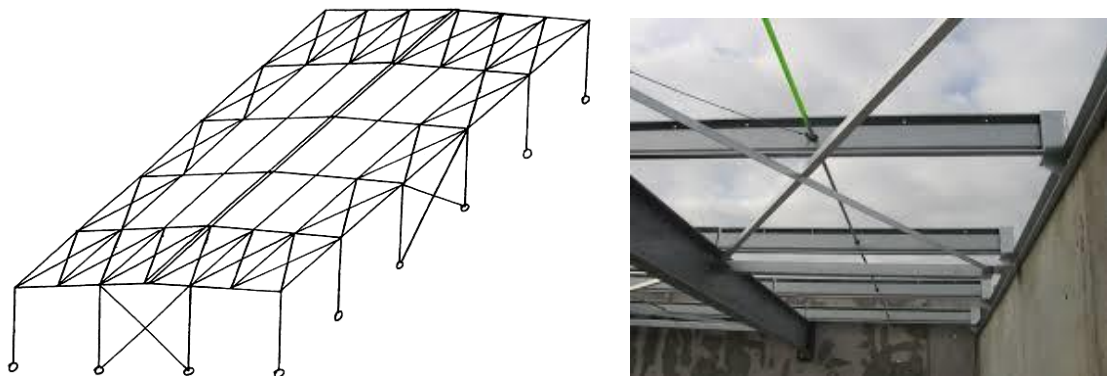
Palée de stabilité et poutre au vent et liernes.
